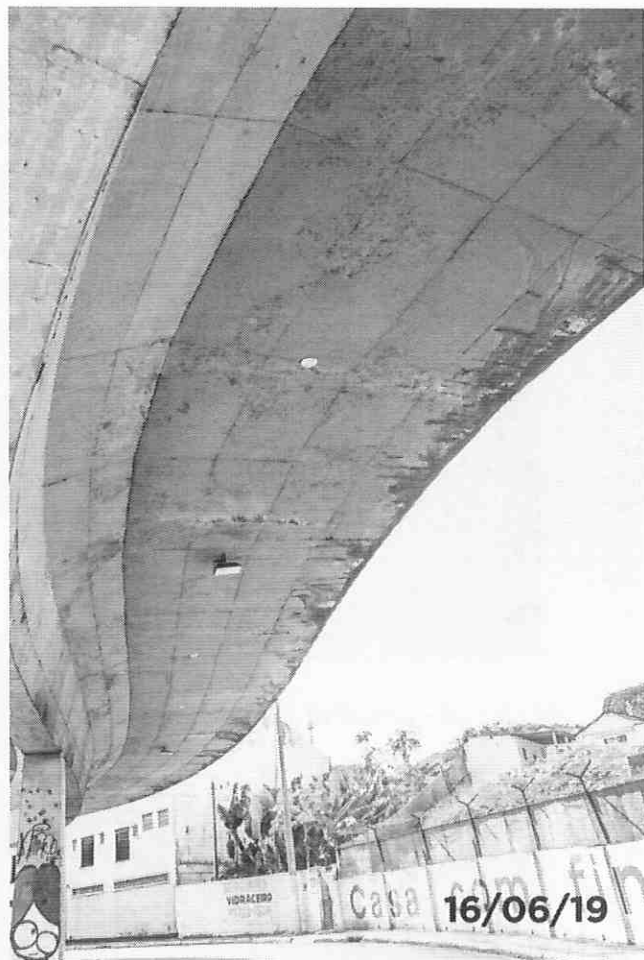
Vista geral frontal inferior da Passarela, detalhe ausência de pingadeira laterais, processo de infiltração e armaduras expostas.
